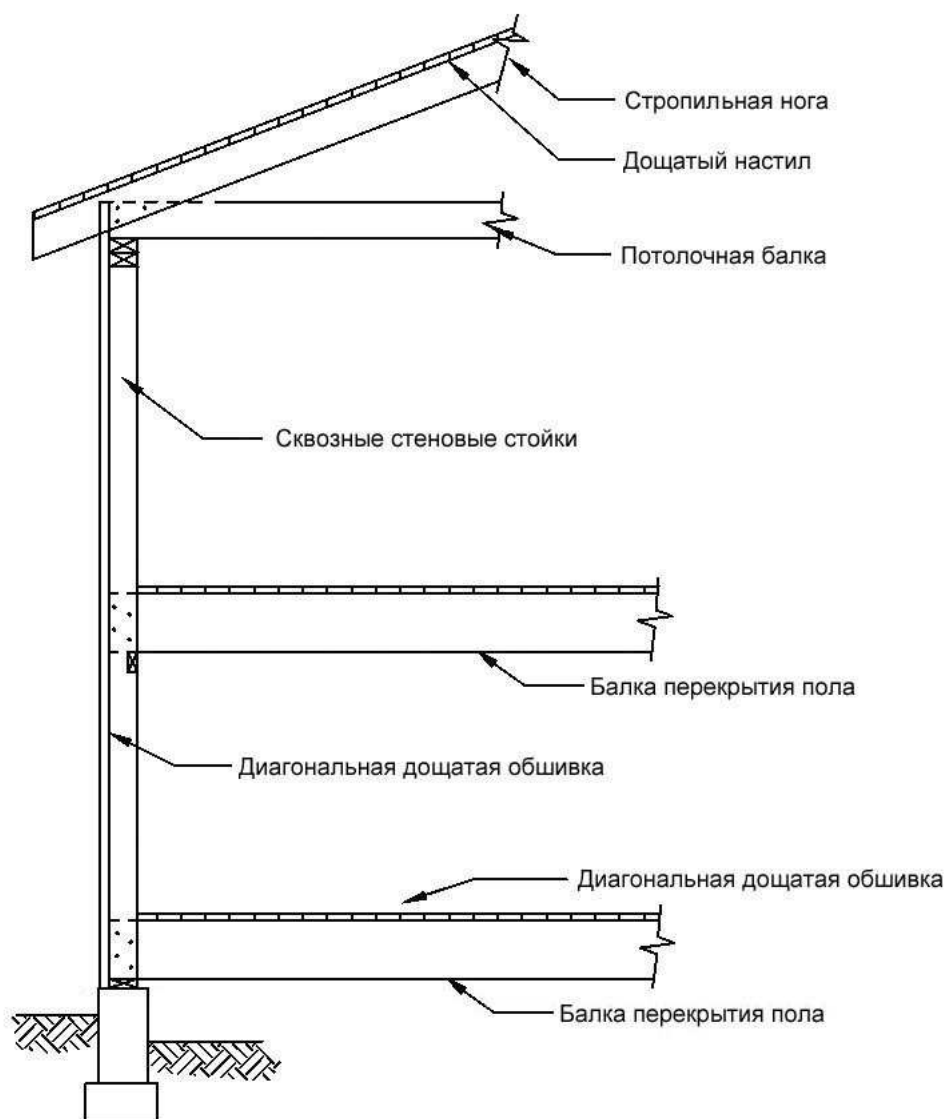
Поперечное конструктивное сечение деревянного дома в виде стоечно-балочного каркаса
